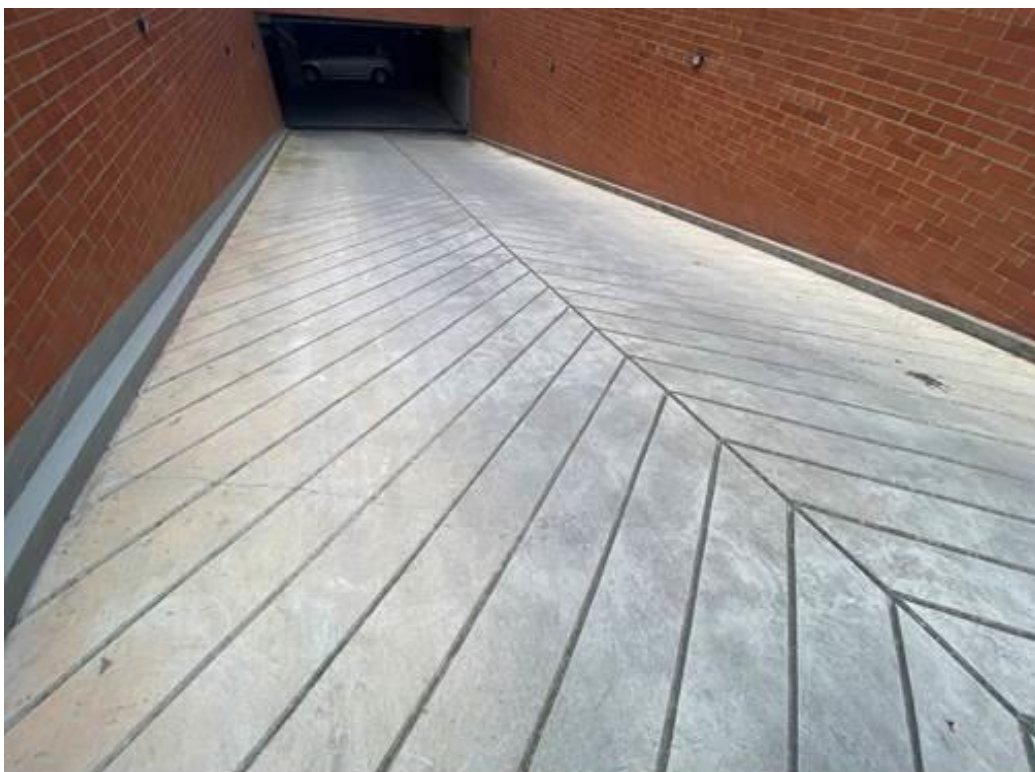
rampa acceso parqueadero con múltiples fisuras
